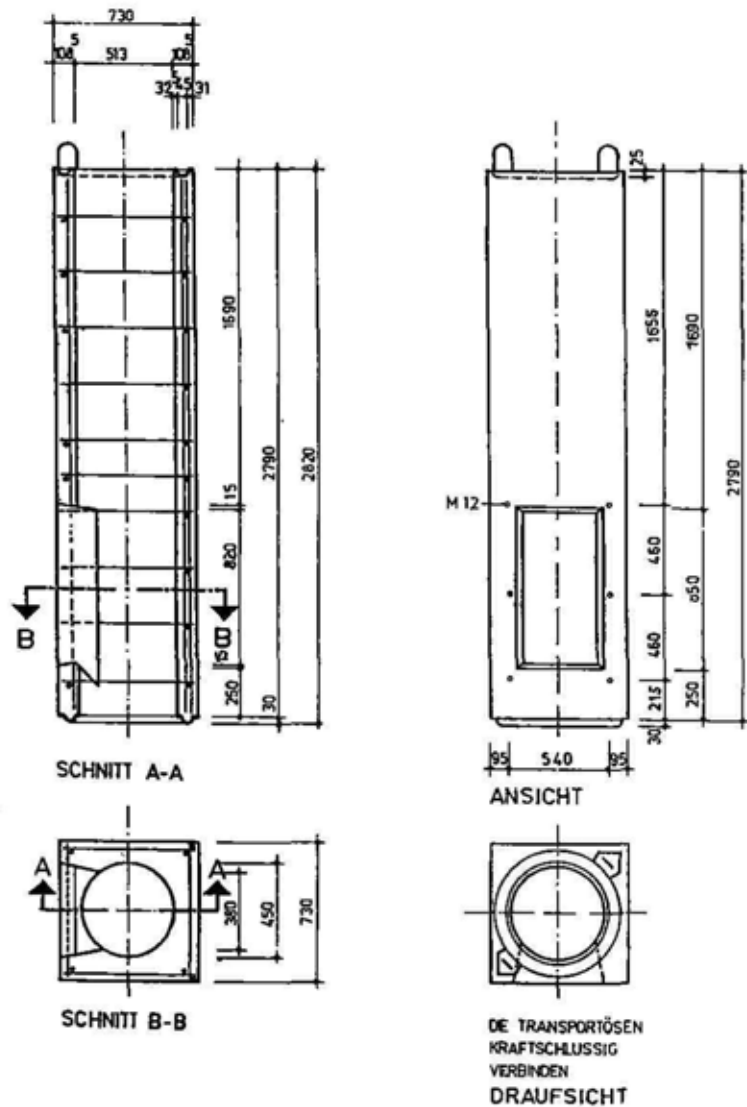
Müllabwurfelement mit Müleinwurföffnung (Maße in mm)
